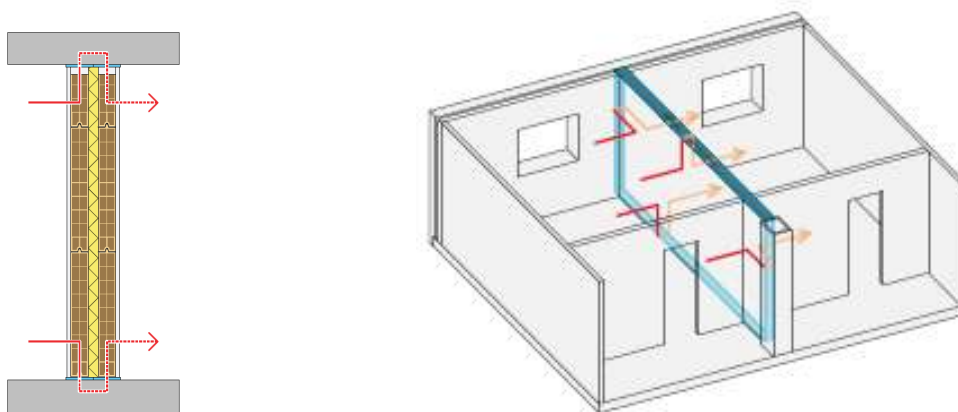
Pared separadora Silensis Tipo 2A: pared doble con bandas elásticas perimetrales en las dos hojas. Interrupción del puente acústico estructural.
